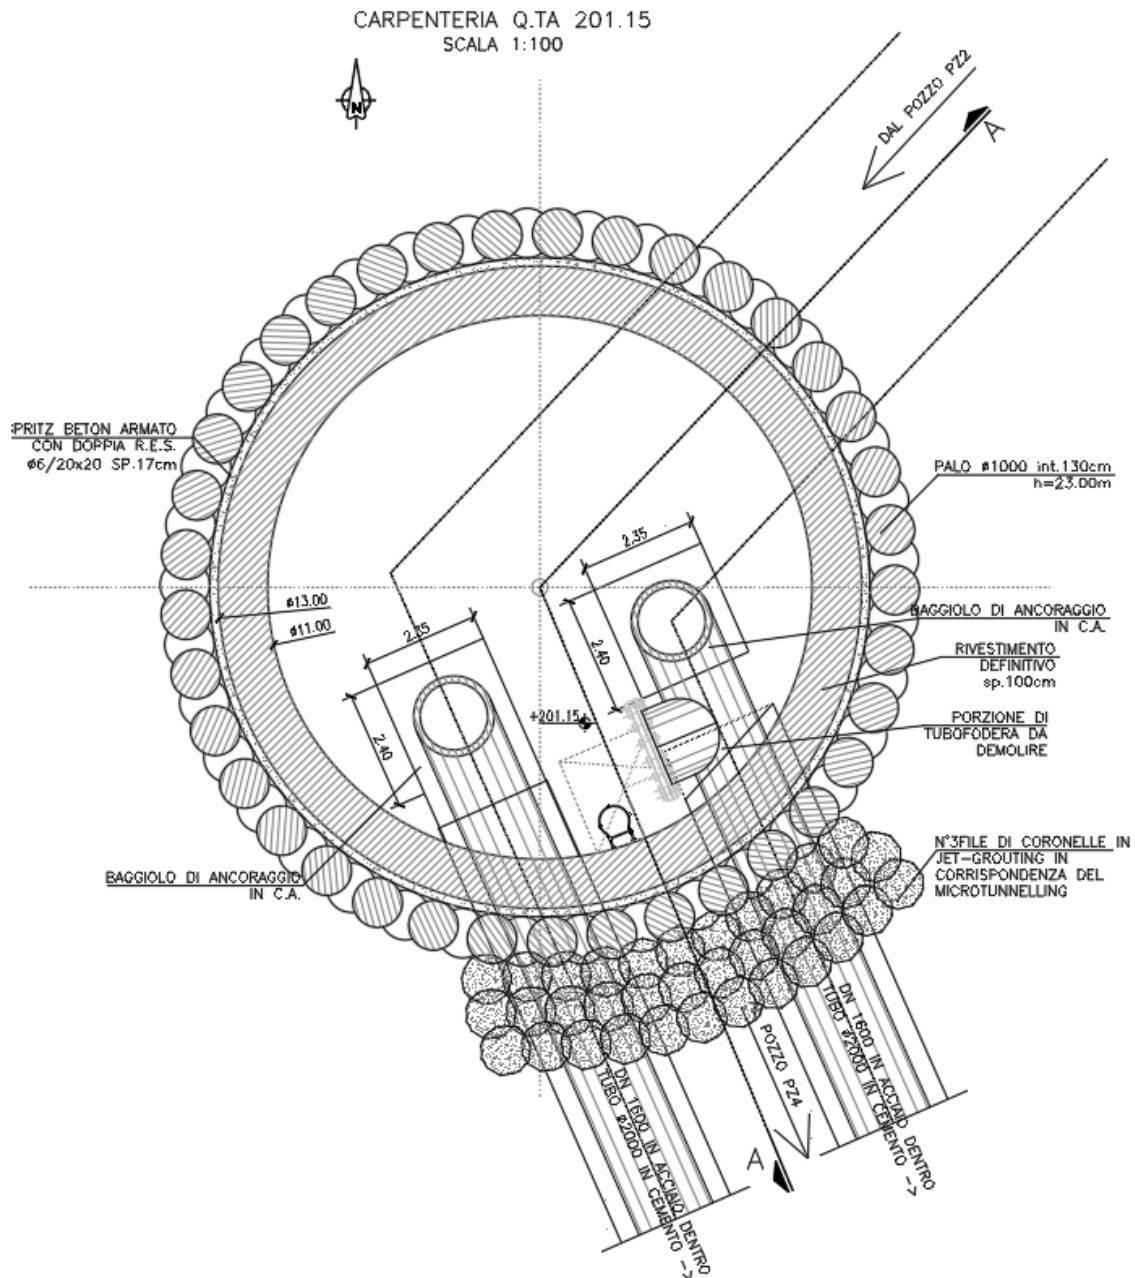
Rappresentazione in pianta del manufatto PZ3 – ripartenza tubazioni
